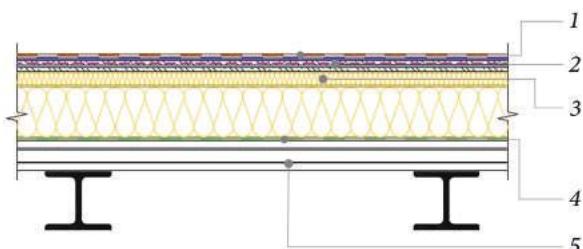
Кровельная система при устройстве сборной стяжки поверх утеплителя из каменной ваты: 1 — гидроизоляционное покрытие (2 слоя); 2 — основание гидроизоляционного покрытия — сборная стяжка; 3 — теплоизоляционный слой из каменной ваты (например *TEXНОРУФ 45*); 4 — пароизоляционный слой; 5 — несущее основание
